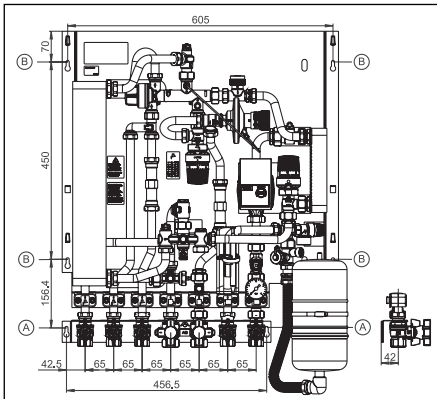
Anschlussschema Kugelhahnanschlussleiste
